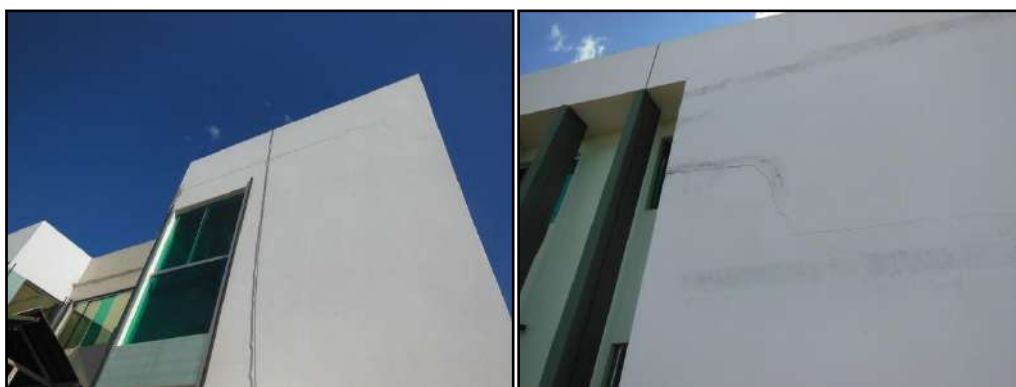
trinca na fachada localizada na platibanda.
